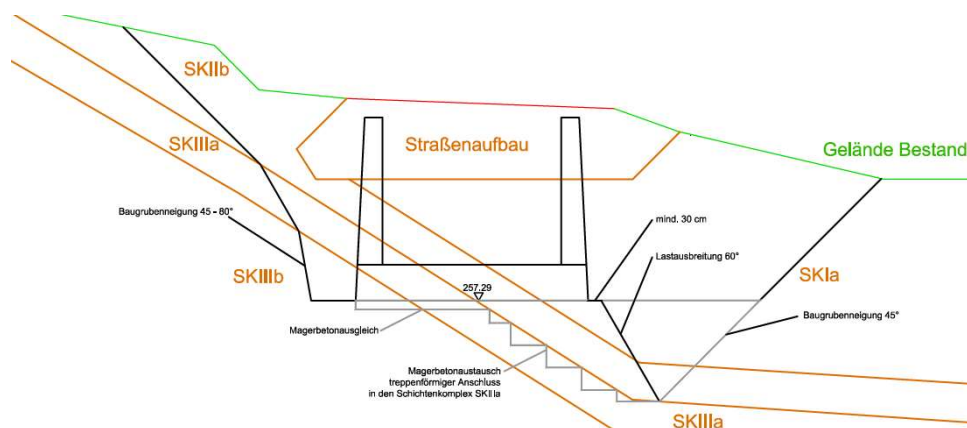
Grundablassbauwerk, Gründung (Schema)
